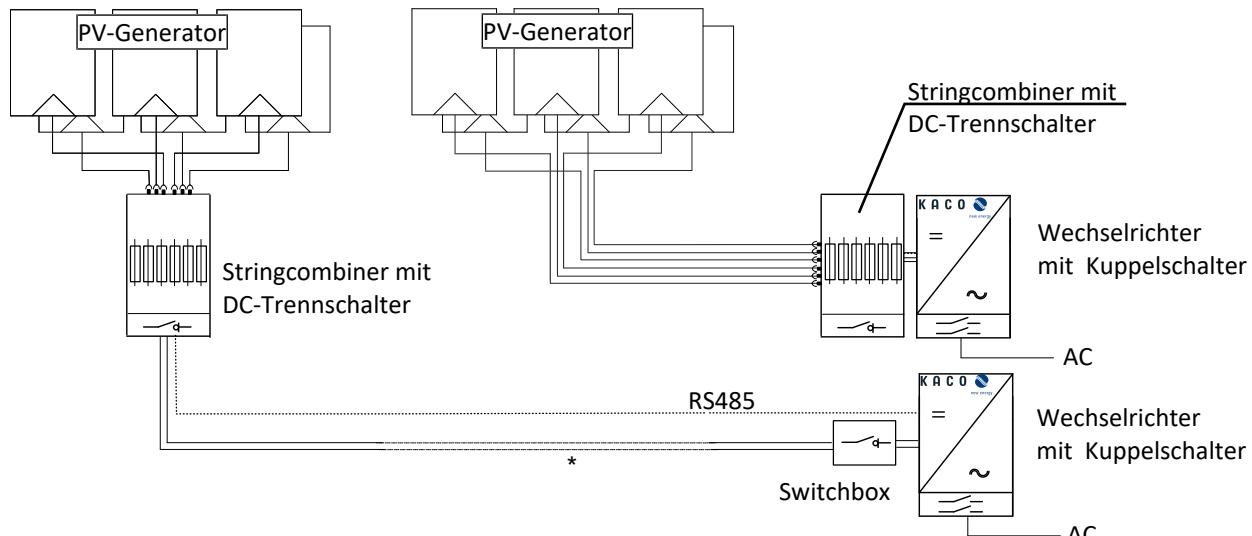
Übersichtsschaltplan mit kurzer oder langer Zuleitung zum Wechselrichter
